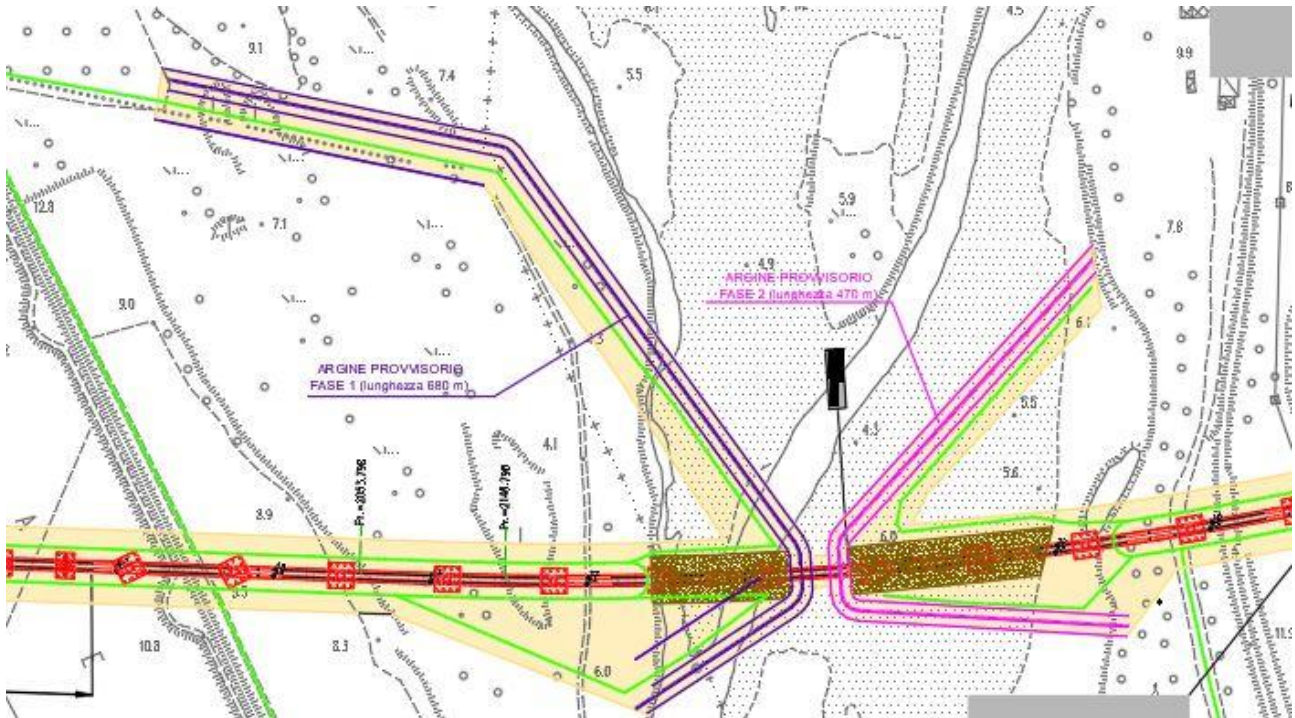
Stralcio planimetrico della cantierizzazione per il tracciato di progetto Variante Isonzo
